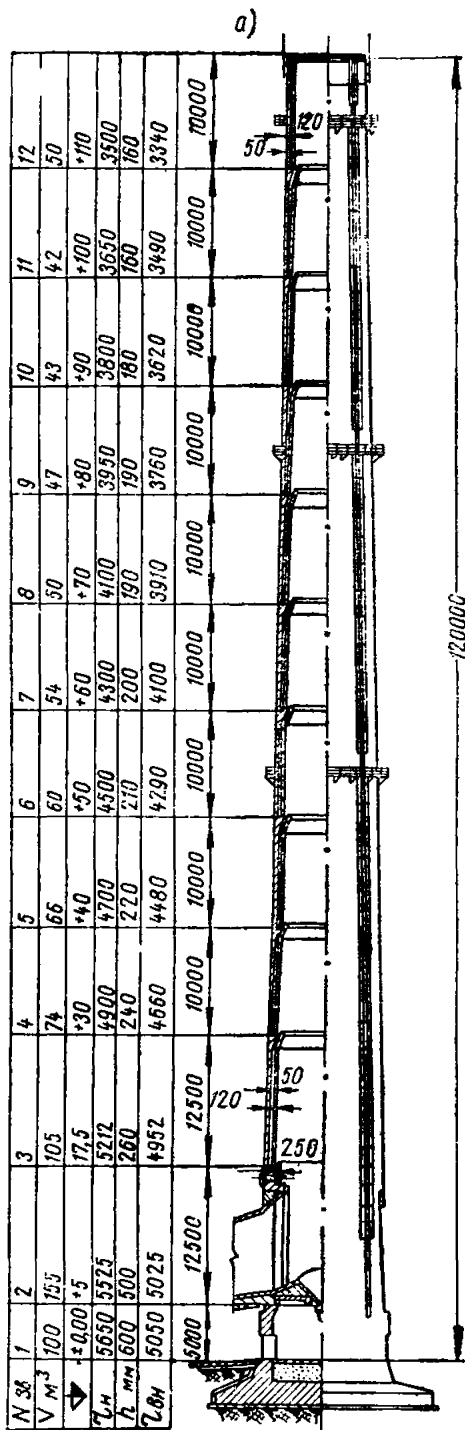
Дымовая труба из обычного железобетона (к примеру расчета № 1)
